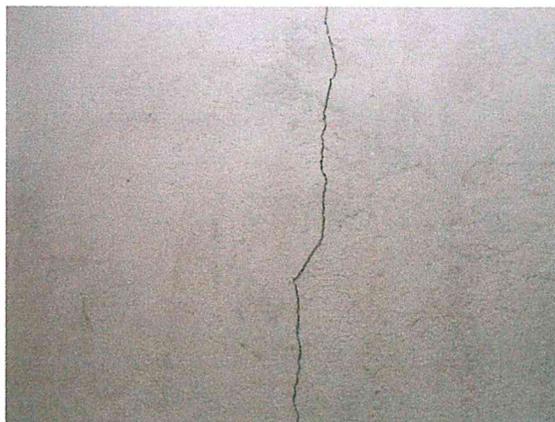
Fisuras en aplanados en el interior de los muros de la rampa peatonal, que no representan ningún riesgo estructural. Se recomienda su sellado.
